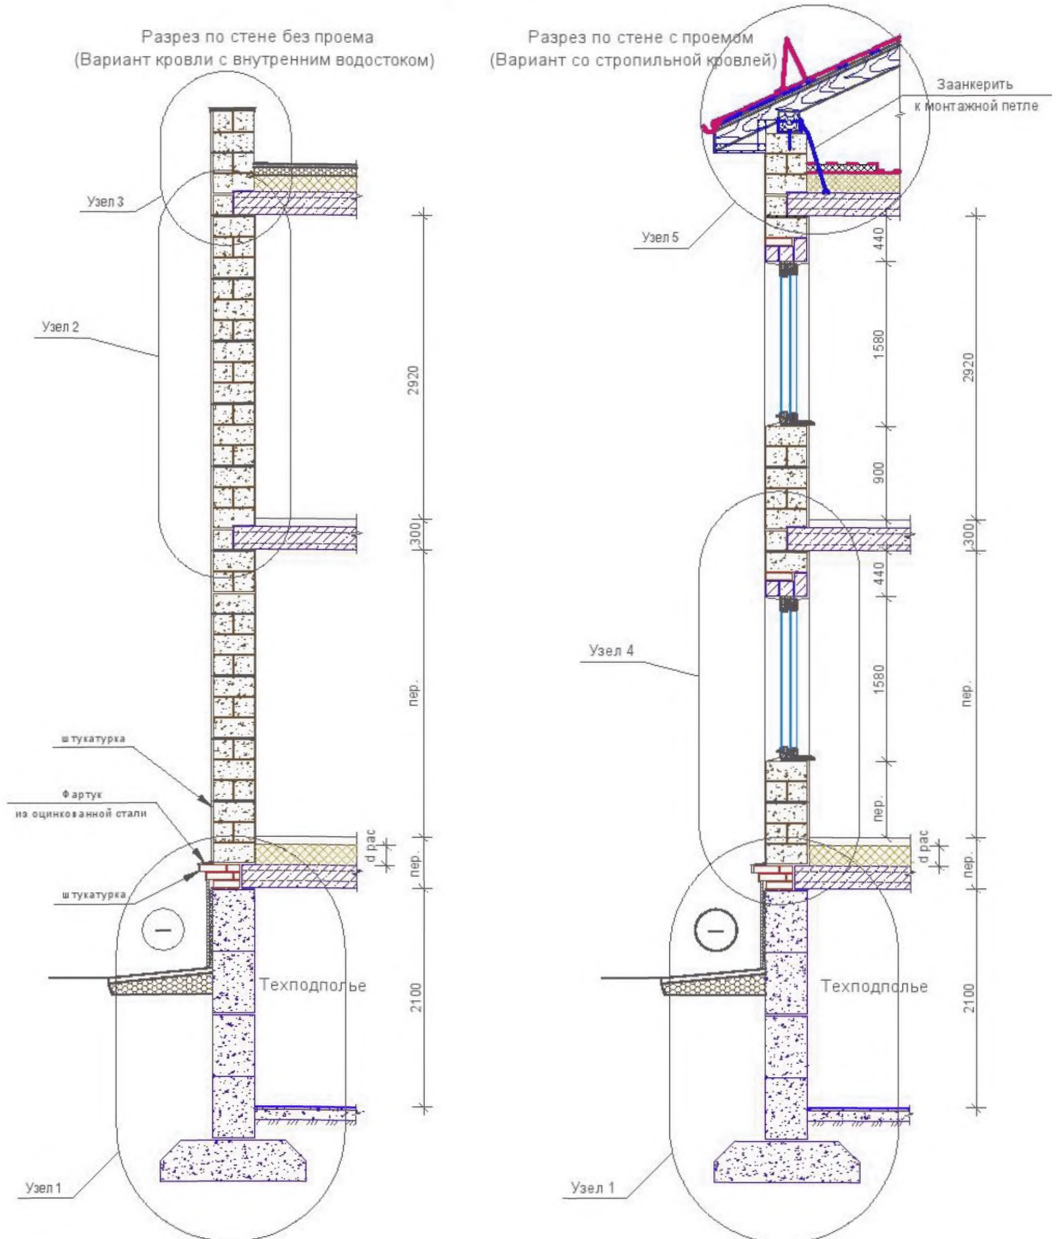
Схема нумерации узлов на поперечном разрезе здания
